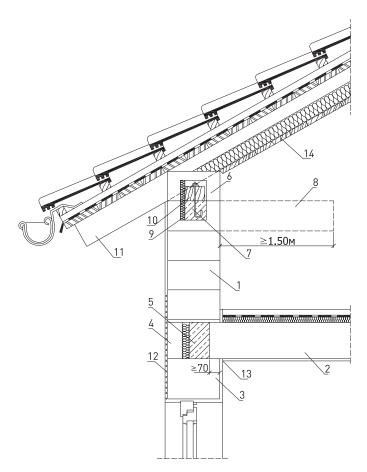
Крыша с деревянной стропильной конструкцией – опирание на наружную стену
